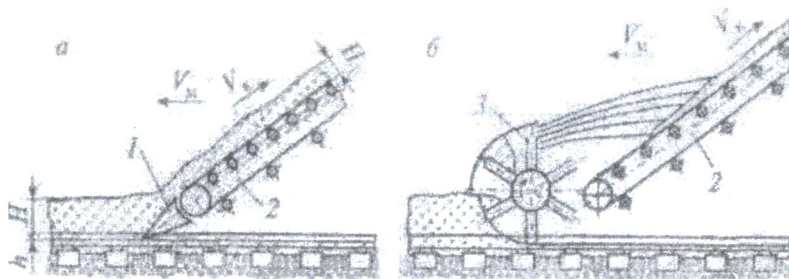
Рабочие органы для забора снега: ножевой (а) и роторный (б): 1 - подрезной нож; 2 - питающий конвейер; 3 -щеточный ротор-питатель
